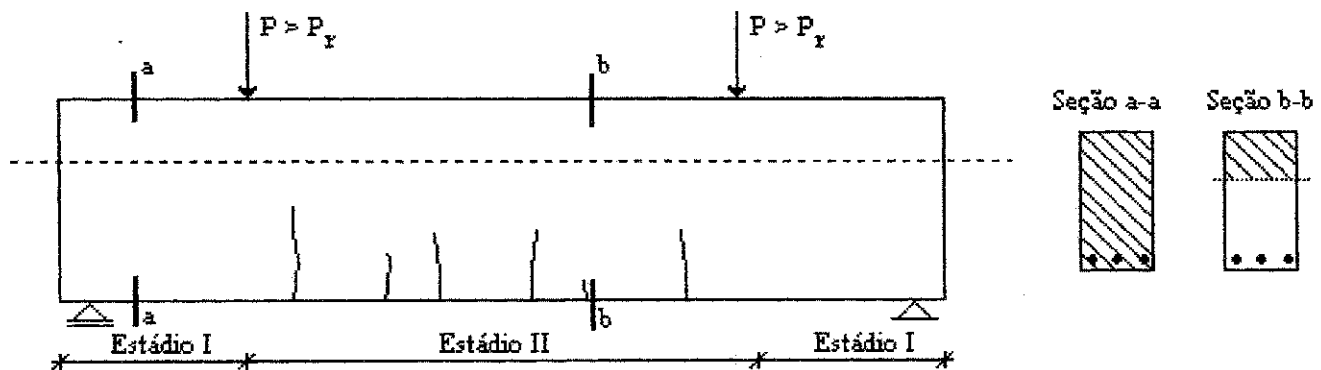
Aparecimento das Primeiras Fissuras
